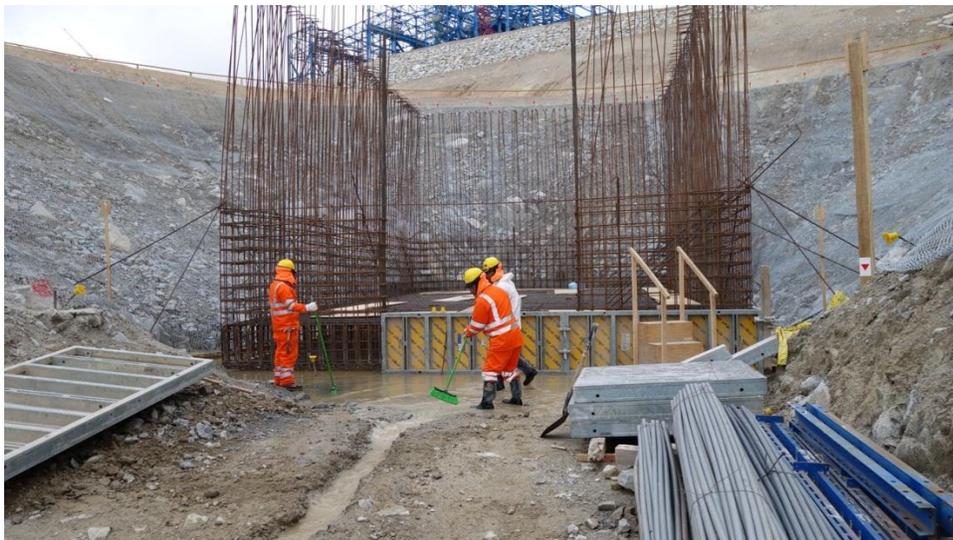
Colocación de acero de refuerzo y encofrado para losa interior.
